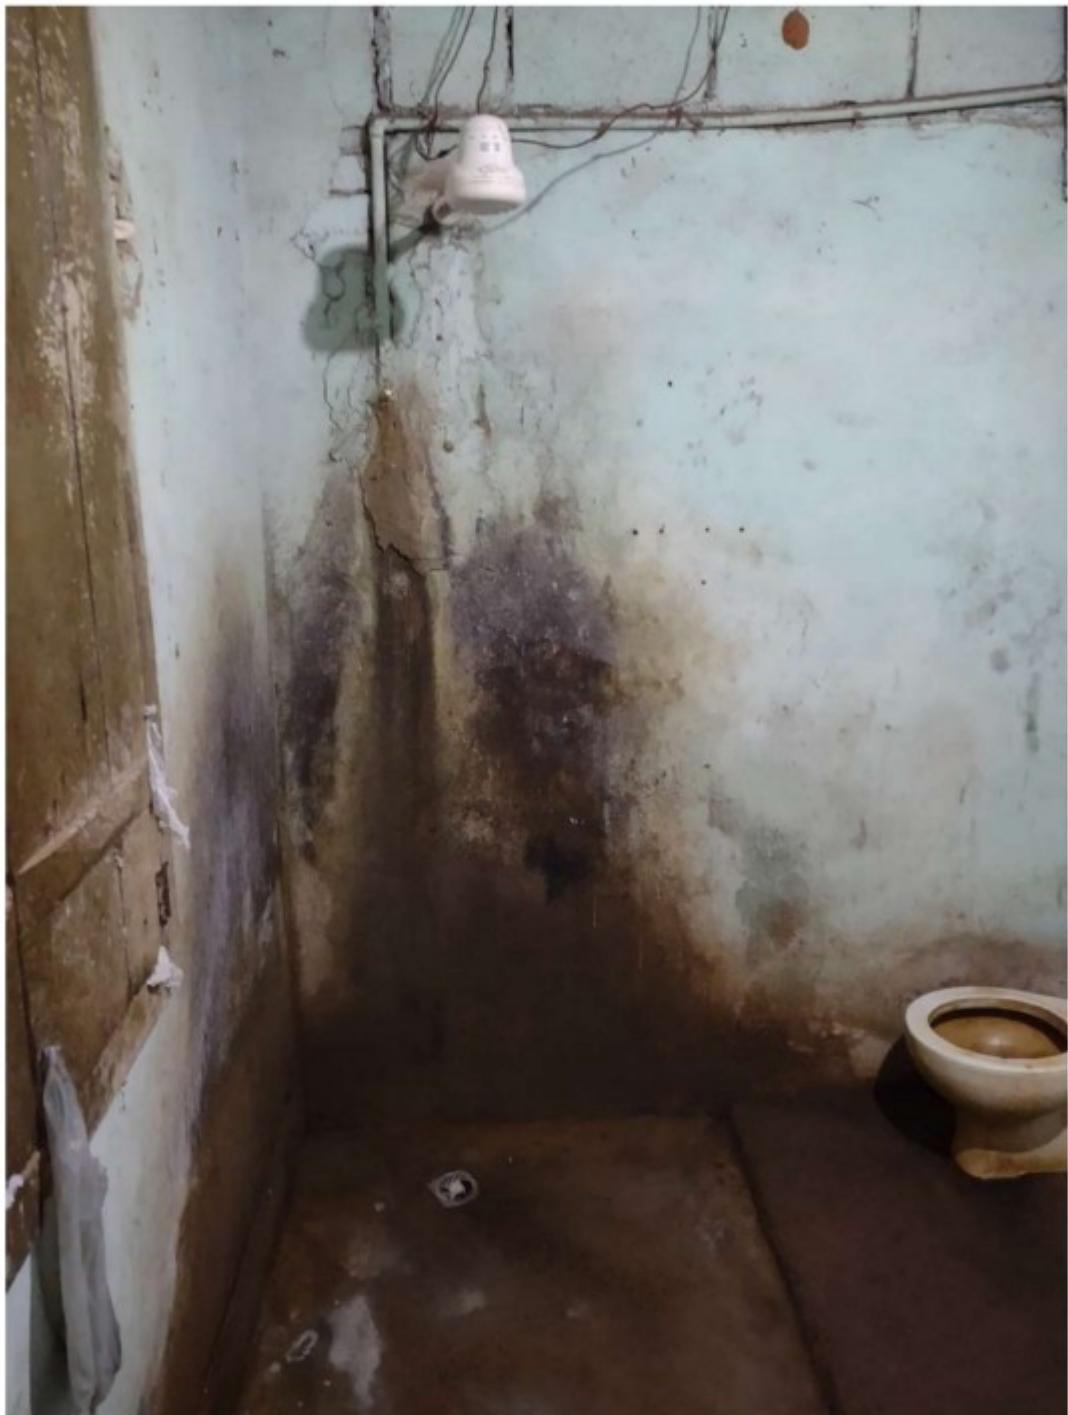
Chuveiro e vaso sanitário do único banheiro interno que havia no casarão.
